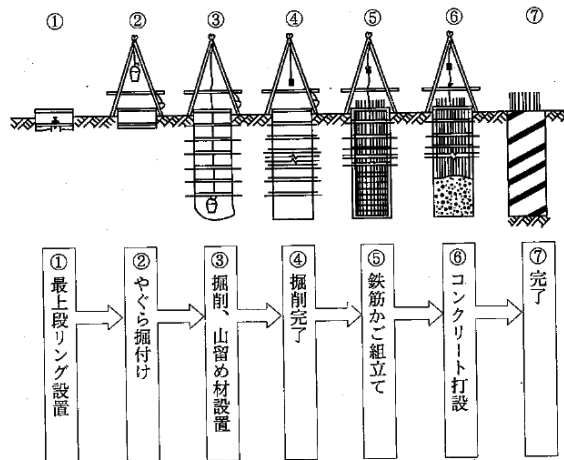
深礎工法の施工手順例（人力掘削の例） 2.12)
